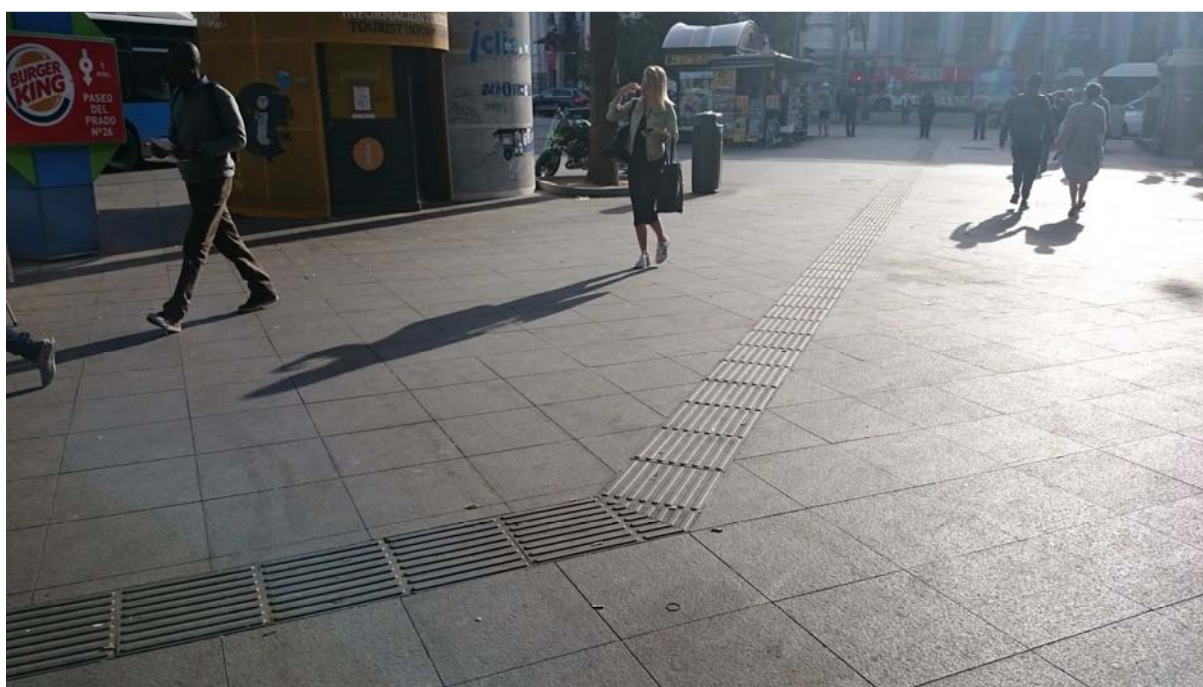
Detalles encaminamiento con cambio de dirección en la Plaza de Cibeles
